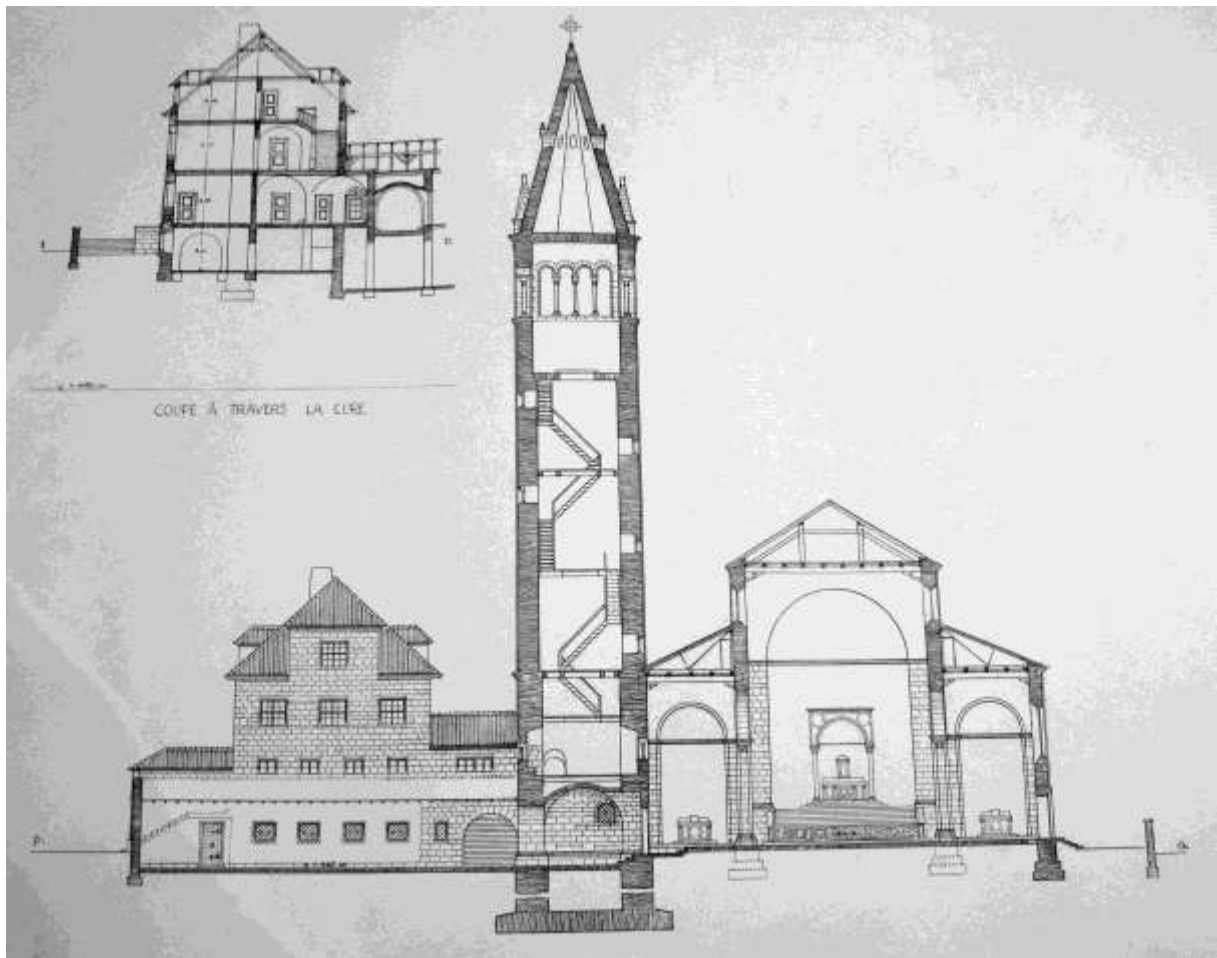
Plans d'exécution, coupe longitudinale, Otto Schmid et Willy Meyer architectes, 1915 (ACV PP 4/5).
